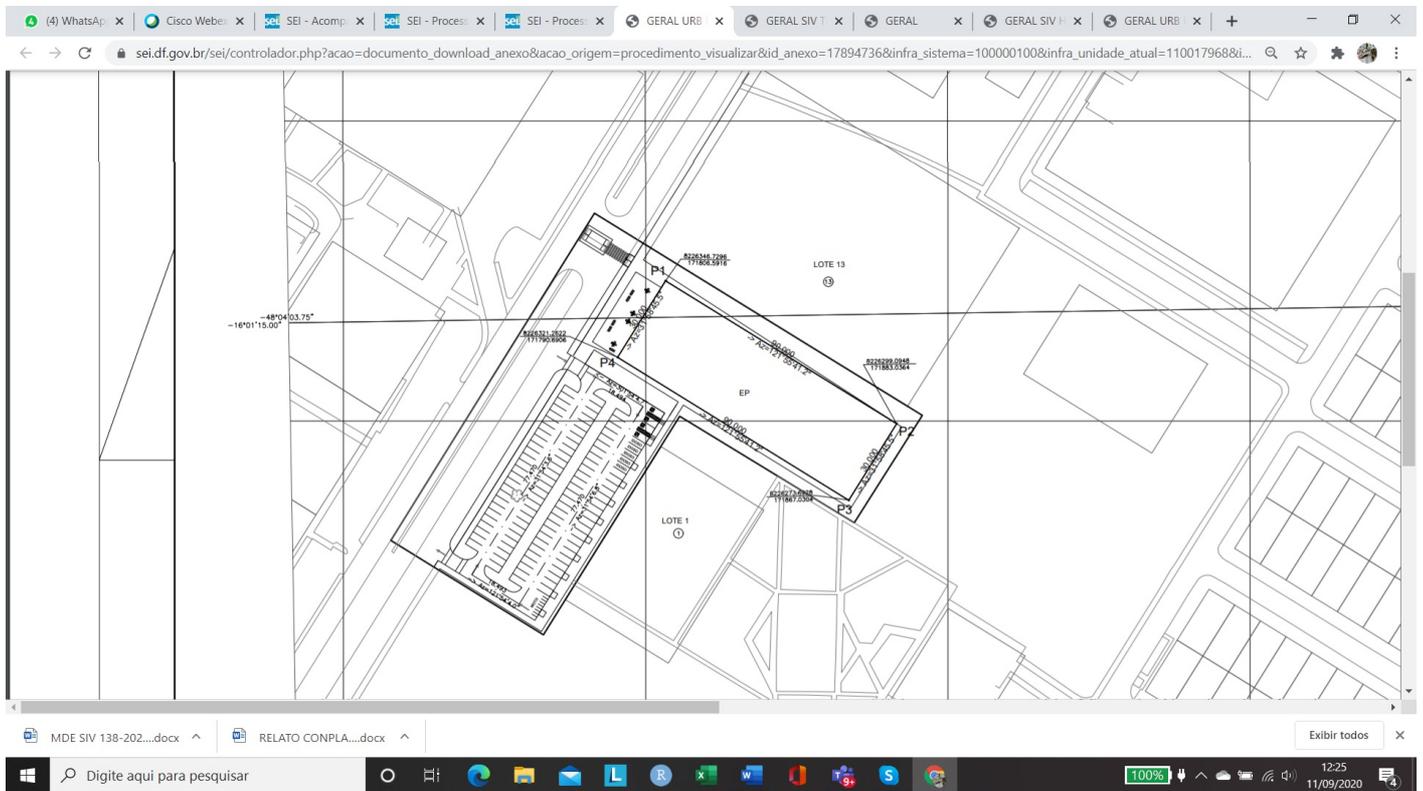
Planta do Projeto de Parcelamento do Solo de novo lote para a Feira do Galpão- URB-MDE 141/2020
